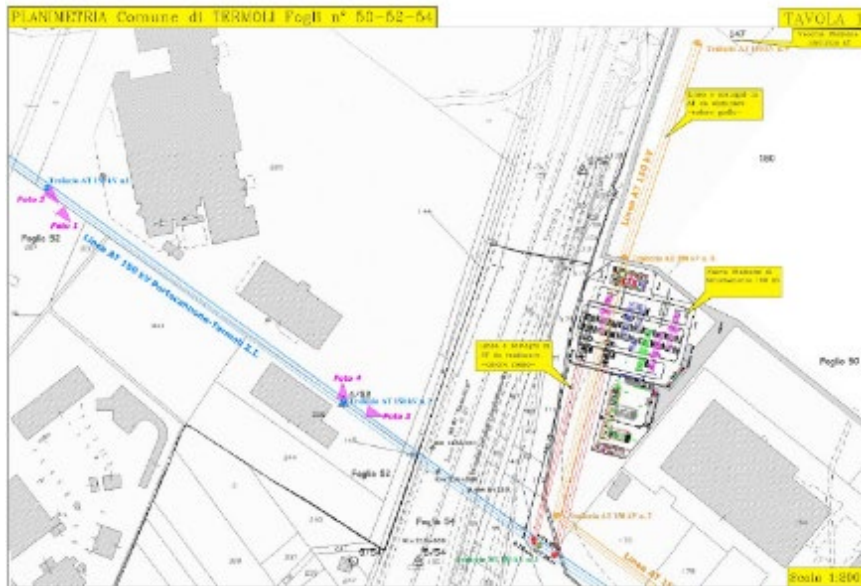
Planimetria nuova Stazione Elettrica 150 kV, di Termoli (CB)
